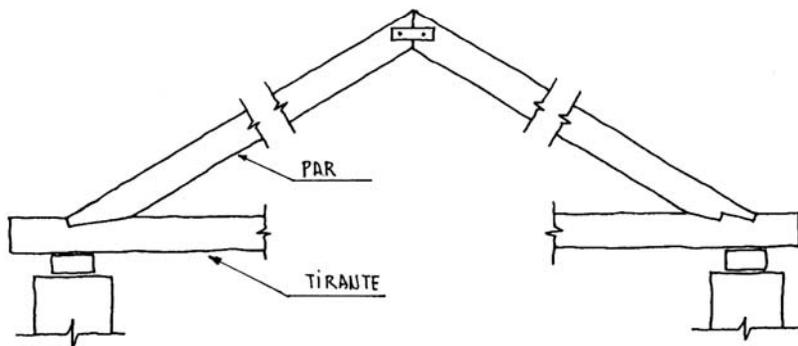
Ensamble de barbilla entre el par y el tirante.
